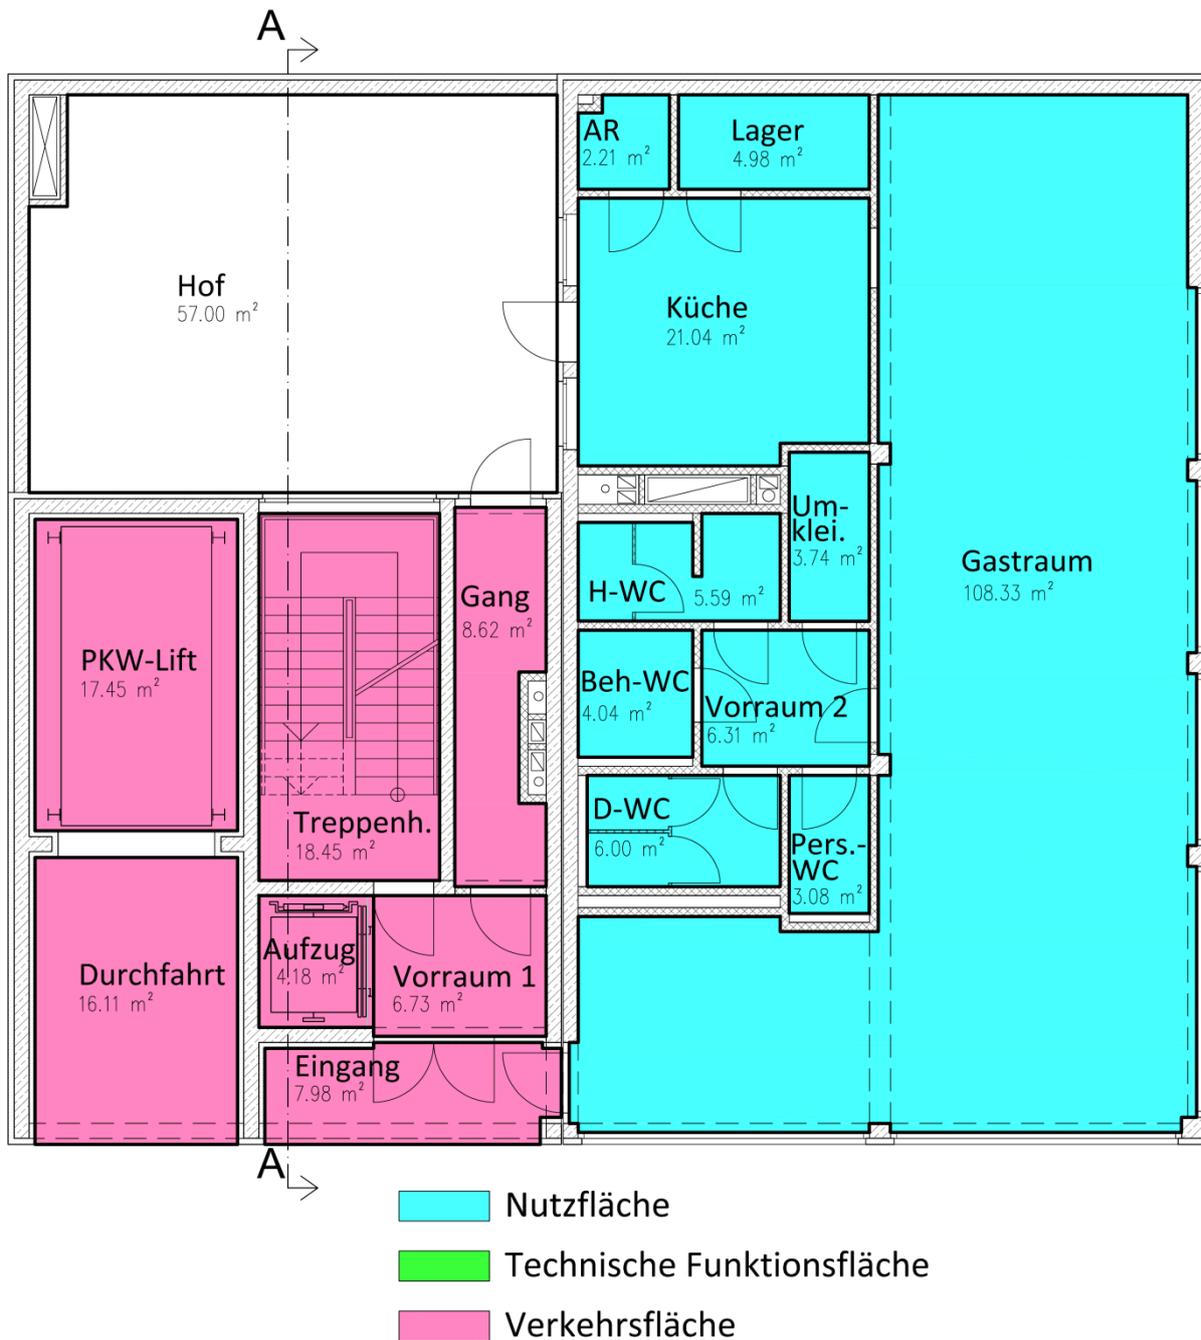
Flächenplan – Grundriss EG
